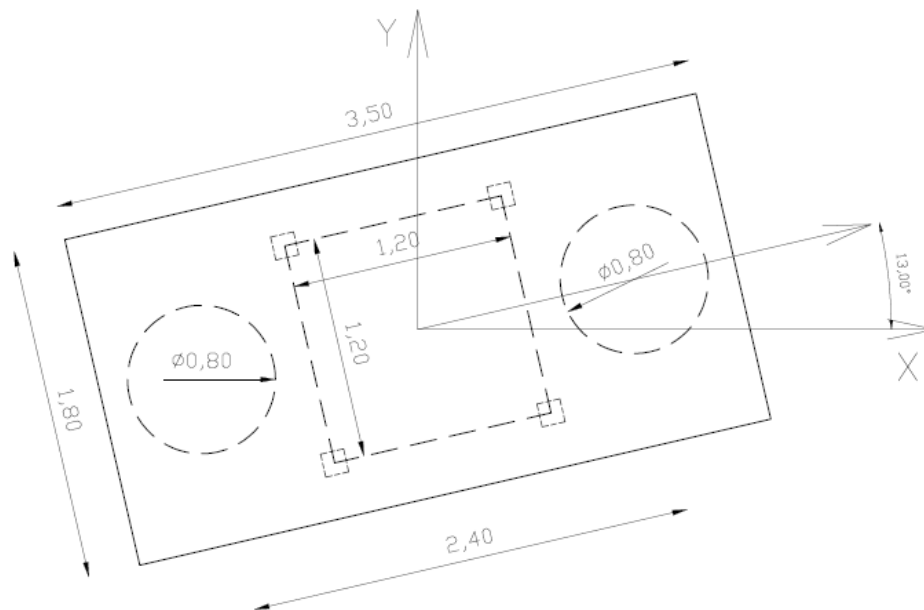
Orientación grupo de 2 pilotes en la traza
